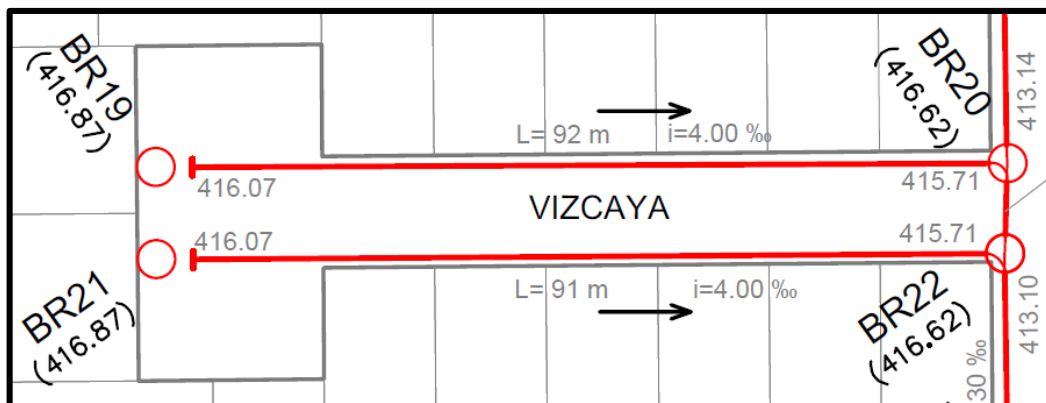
Tramos que van por calle. (Fuente: Elaboración propia)
